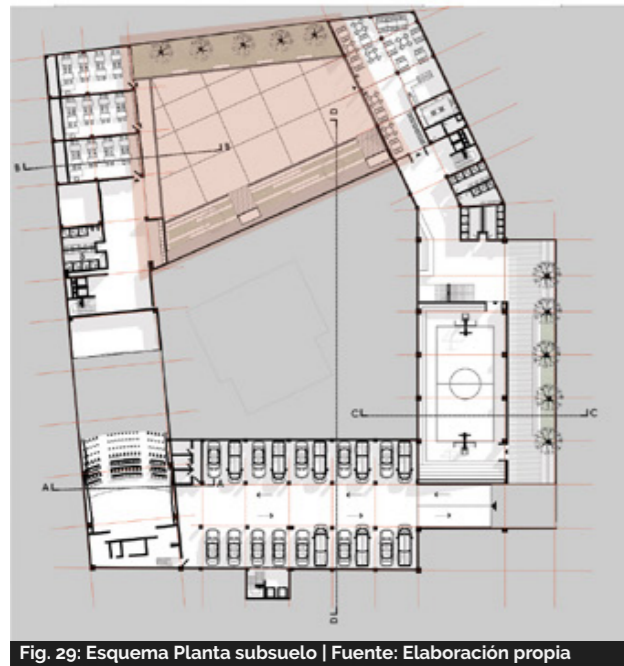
Esquema Planta subsuelo | Fuente: Elaboración propia
